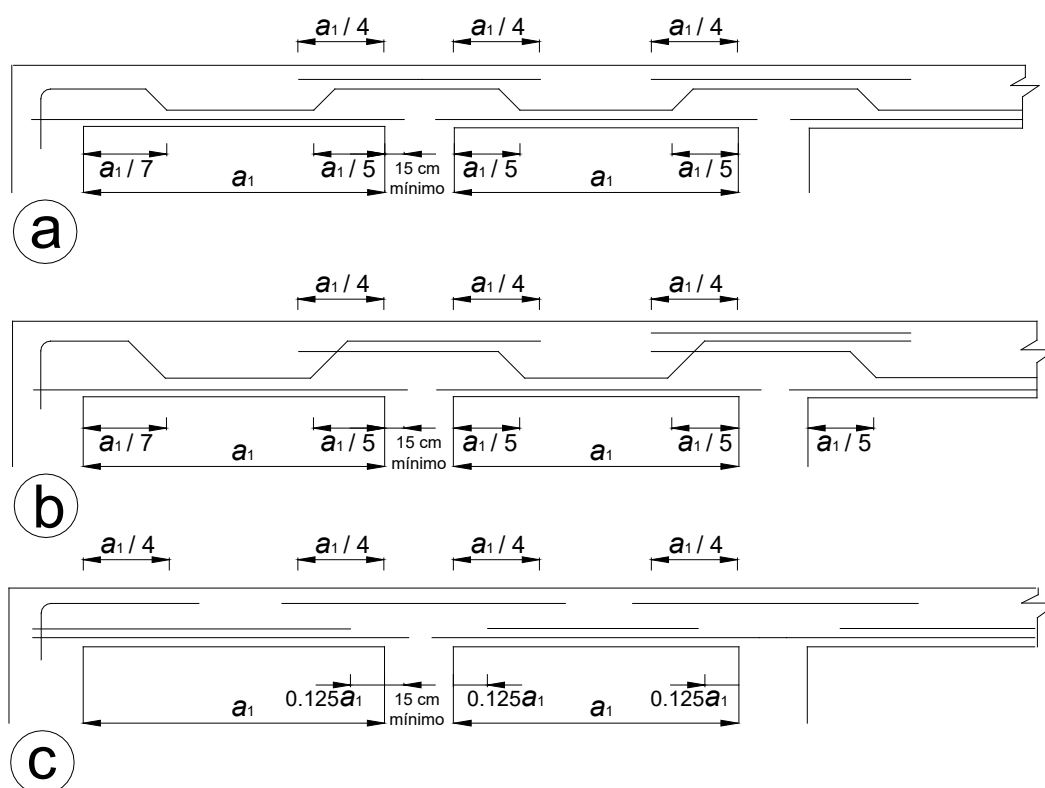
Detalles típicos del refuerzo de losas (González 2005)
